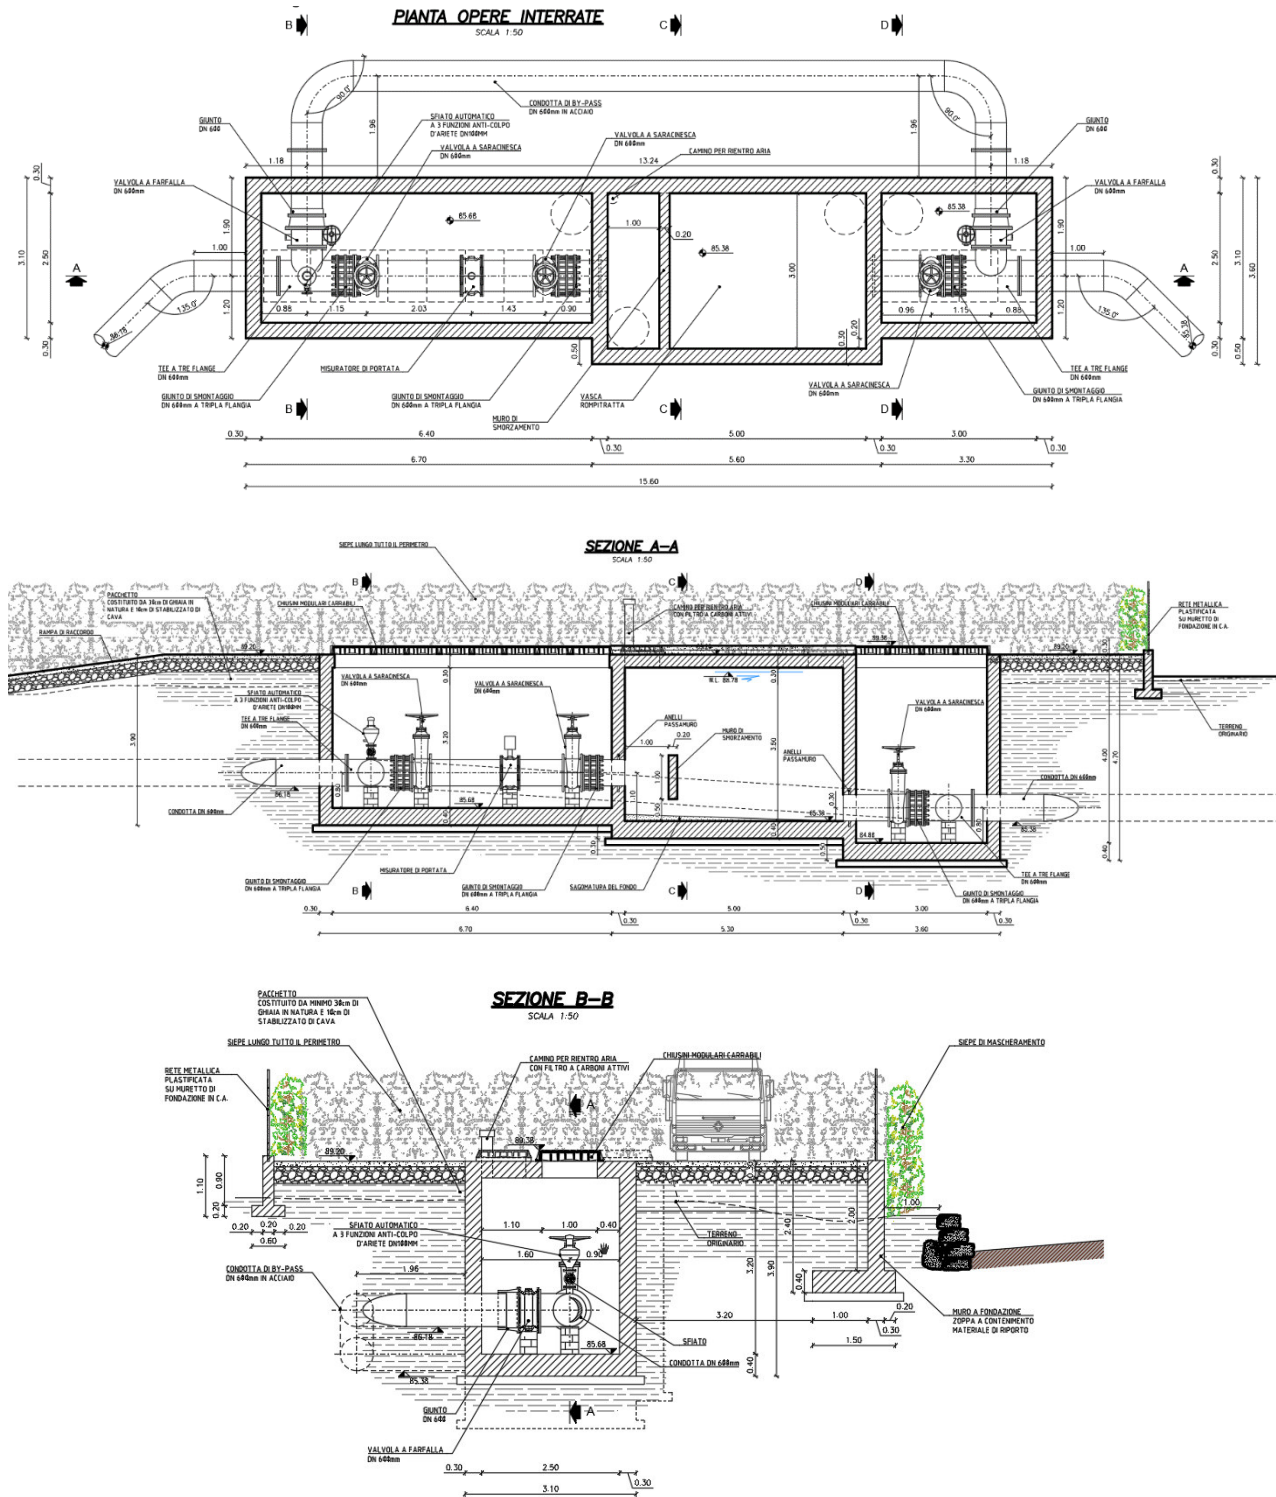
Pianta e sezione longitudinale della vasca rompitratte.
